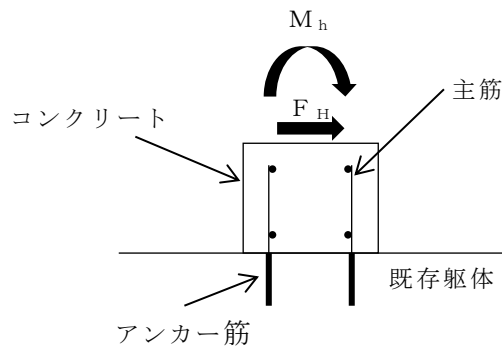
地震時の鉄筋コンクリート製堰に生じる力の断面概念図
